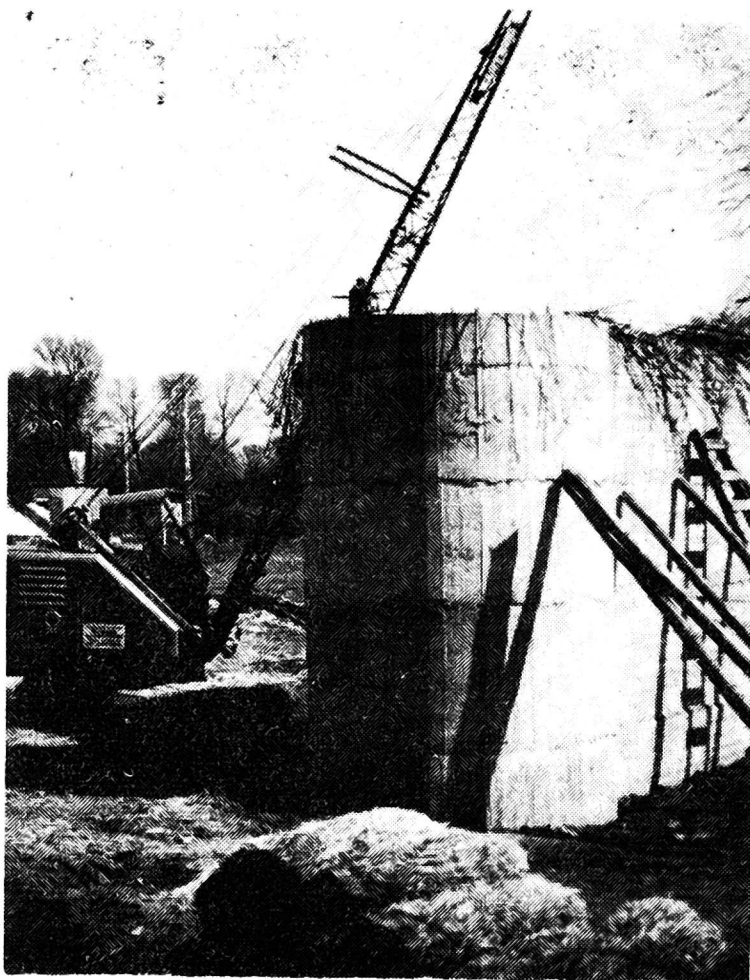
Zapuszczanie studni fundamentowej stacji pomp
